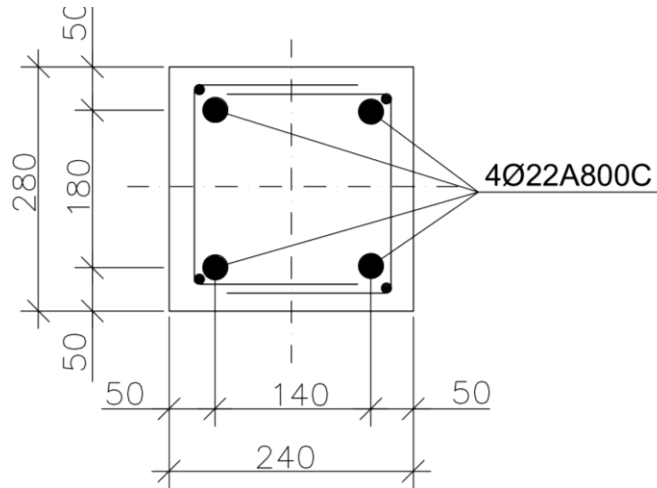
Схема розташування арматури в перерізі нижнього поясу
